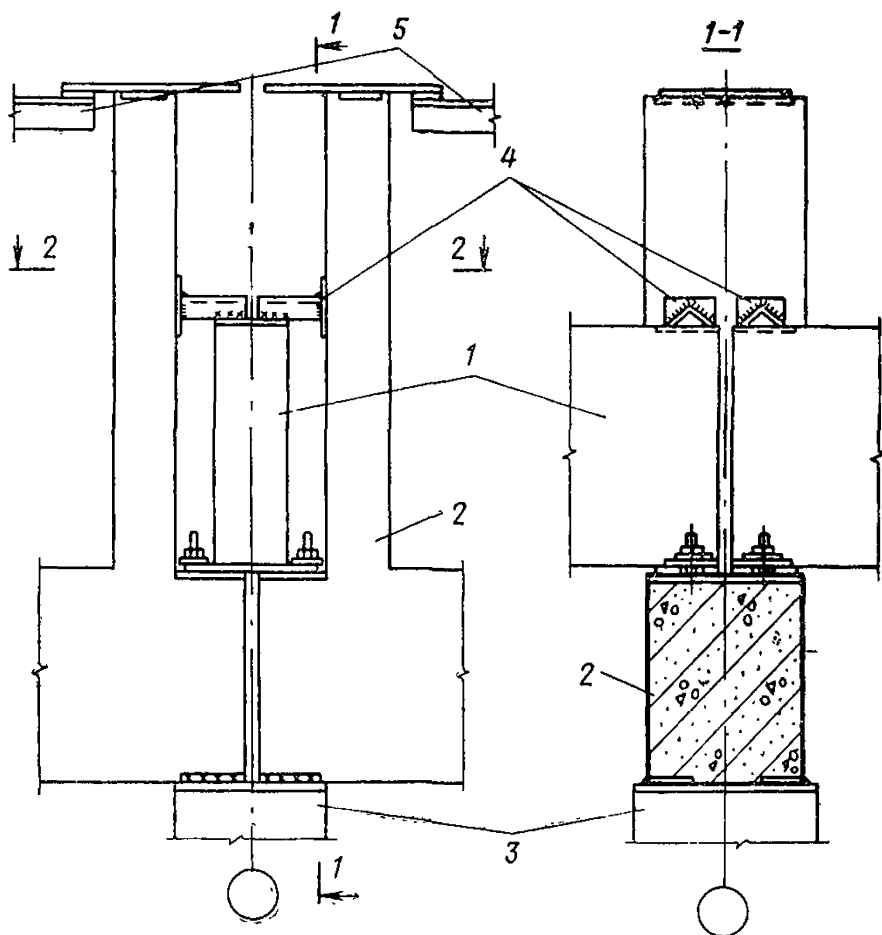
Крепление стропильных ферм к подстропильным в месте опирания их на колонну (при скатной кровле) в зданиях с расчетной сейсмичностью 8 баллов
